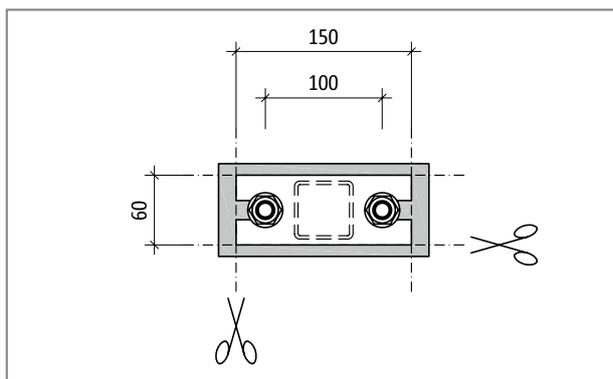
Schöck Isokorb® T type S-V : dimensions après découpe du corps isolant
